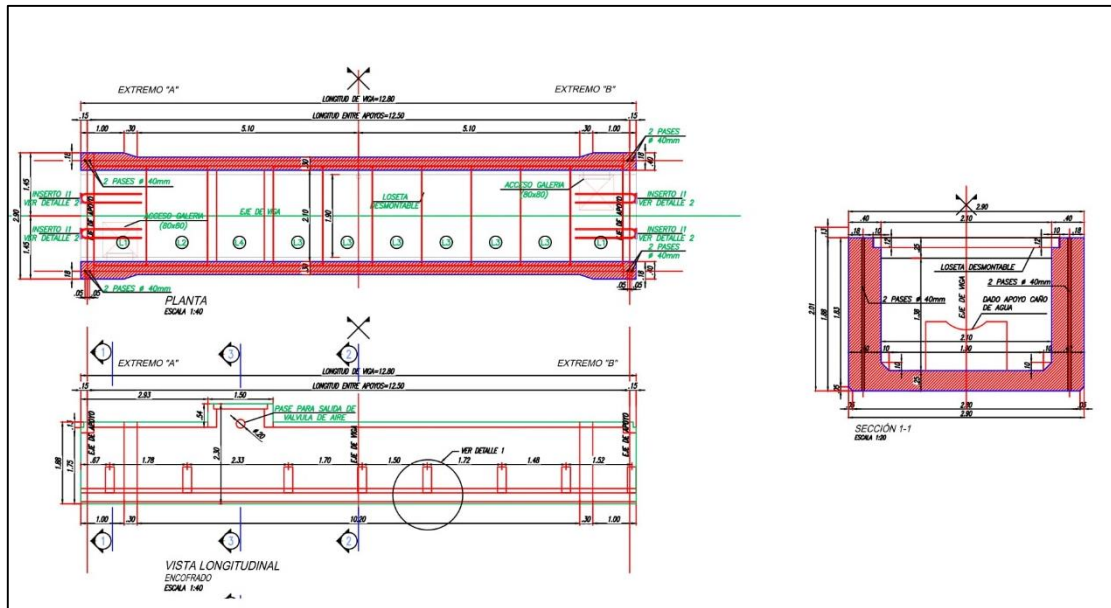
Detalle viga cajón. (PLANO N° 28)
